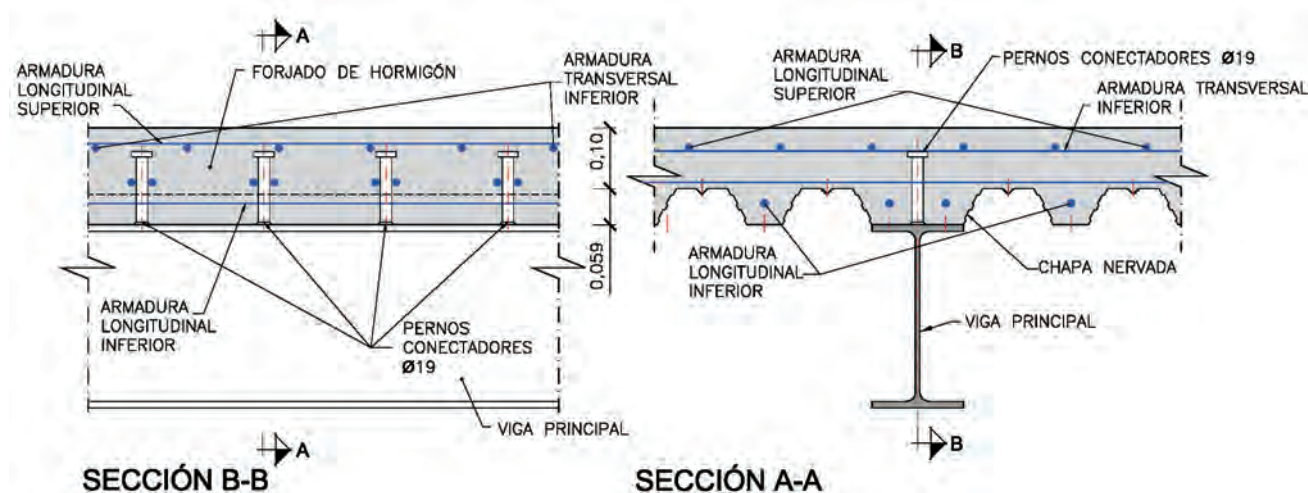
Esquema de forjados mixtos y detalle de viga principal mixta conectada al forjado
